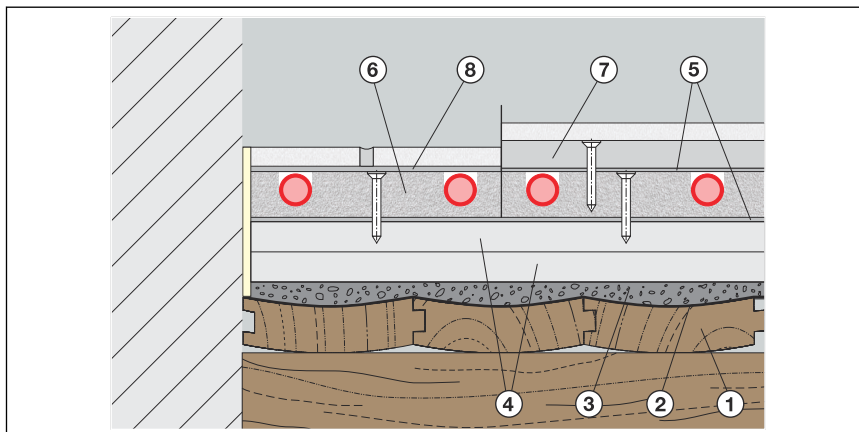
Sottostruttura con elemento di massetto e riempimento in gessofibra
